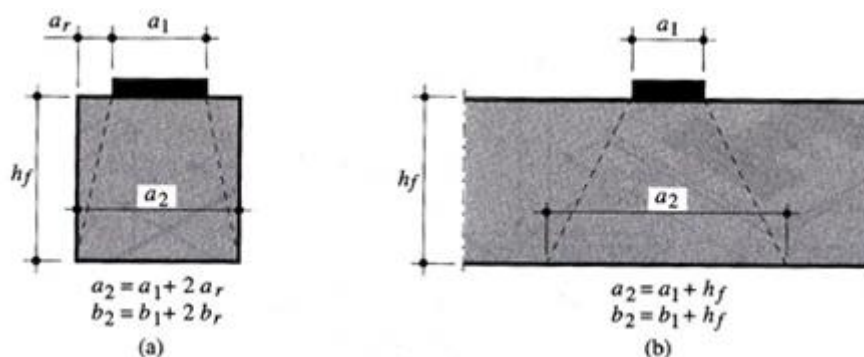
Tipos de fundação: a) fundação curta; b) fundação comprida (Hirt, M.A.; Crisinel, M., 2005)
